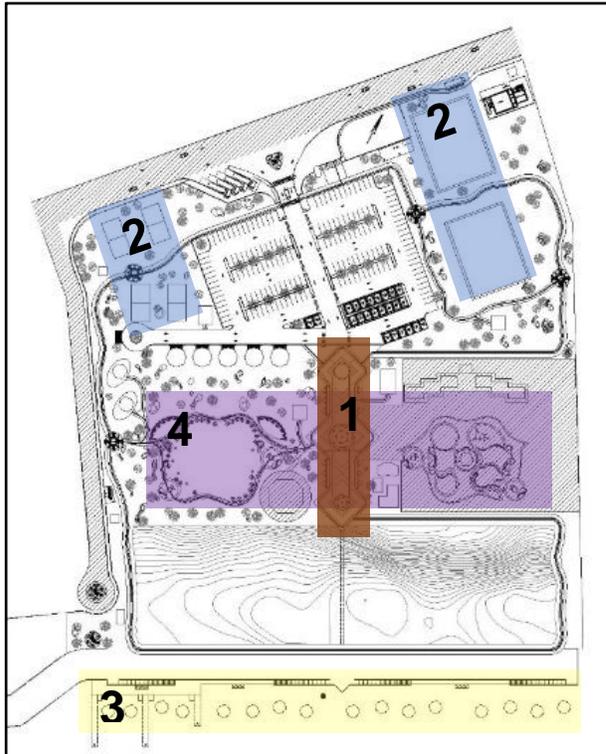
Planta de conjunto. Fuente: Puebla Arquitectos, 2017.
